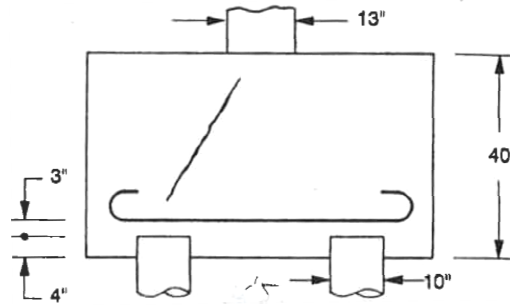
Ejemplo de diseño de un ecapado de dos pilotes: Alzado mostrando fisura en la dirección principal de compresión [10]
